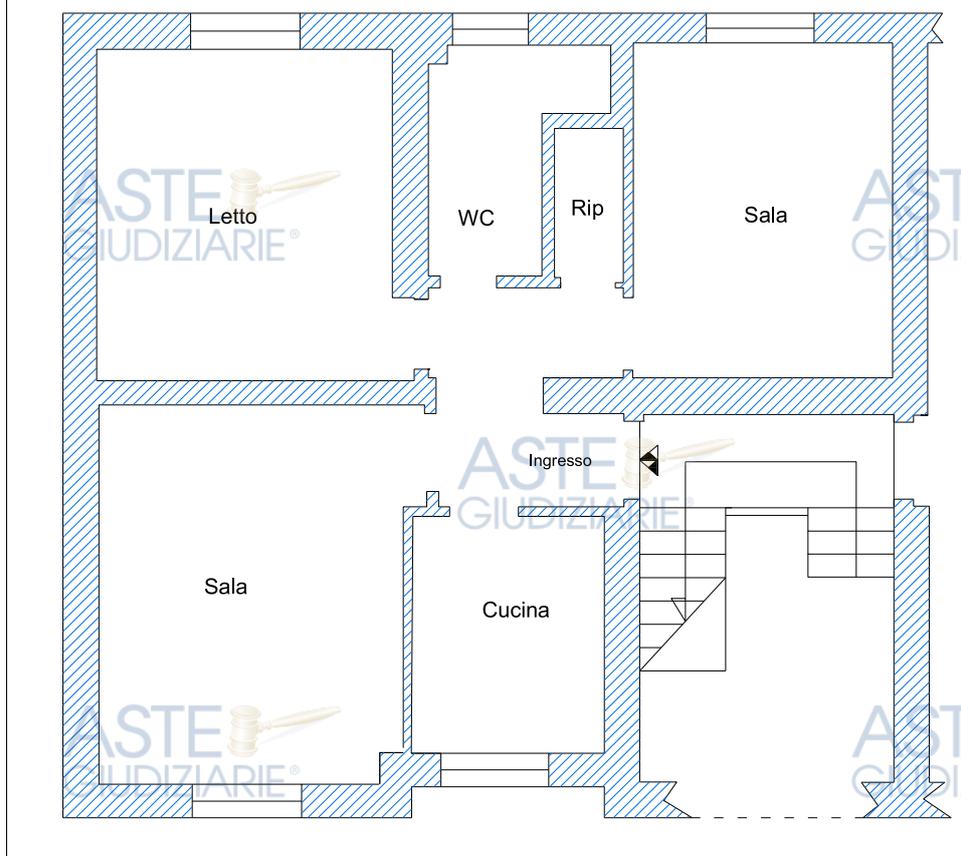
Pianta dell'immobile identificato al foglio 6 part.225 sub 2. Piano rialzato.
